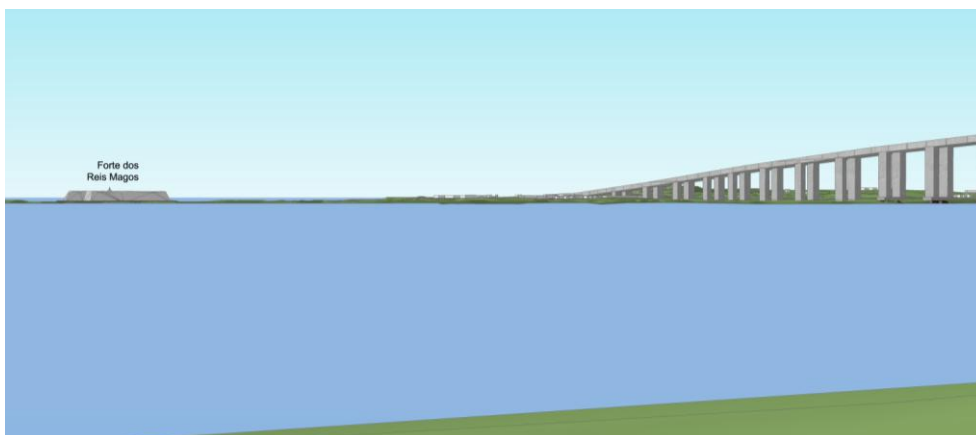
Simulação tridimensional da situação atual de implantação dos elementos da paisagem da ZPA7. Vista do calçadão da Região Norte (Redinha).
